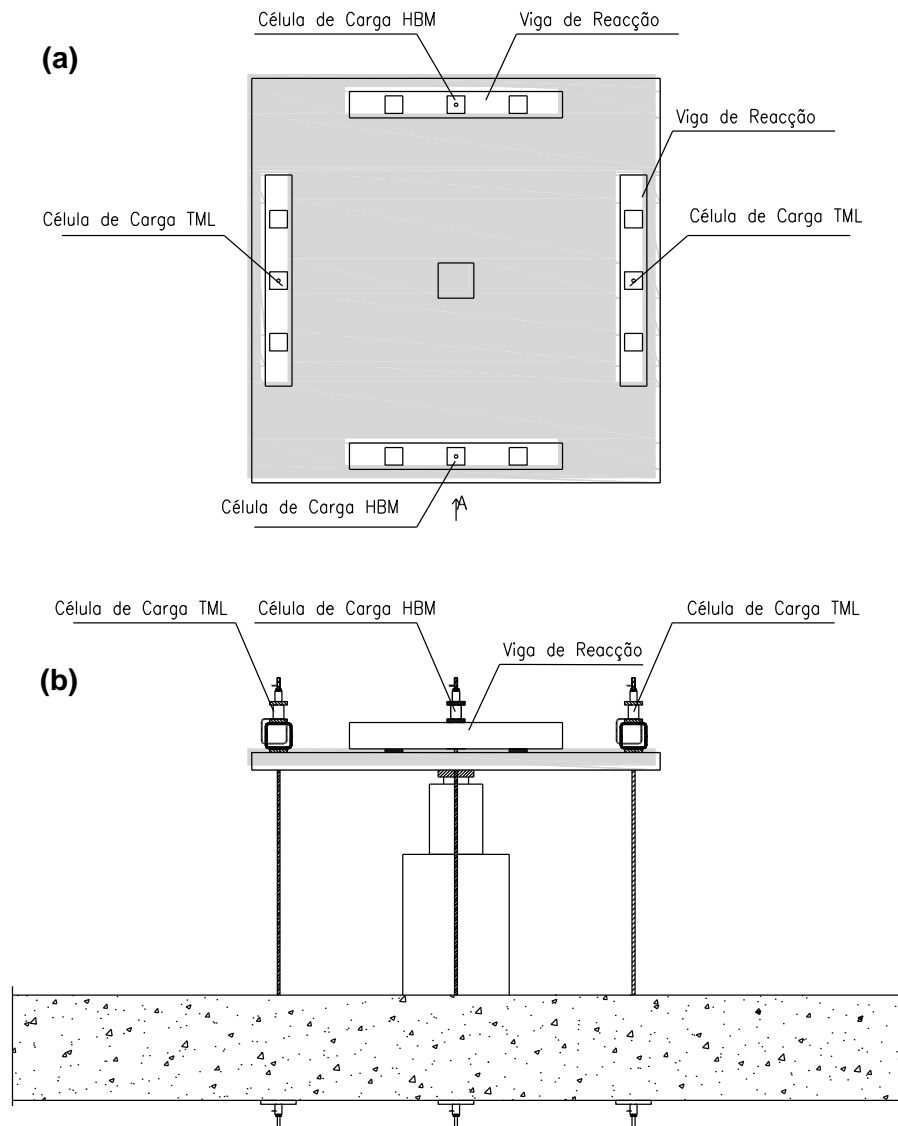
Localização em planta e em corte das células de carga, (a) planta, (b) vista por A.
